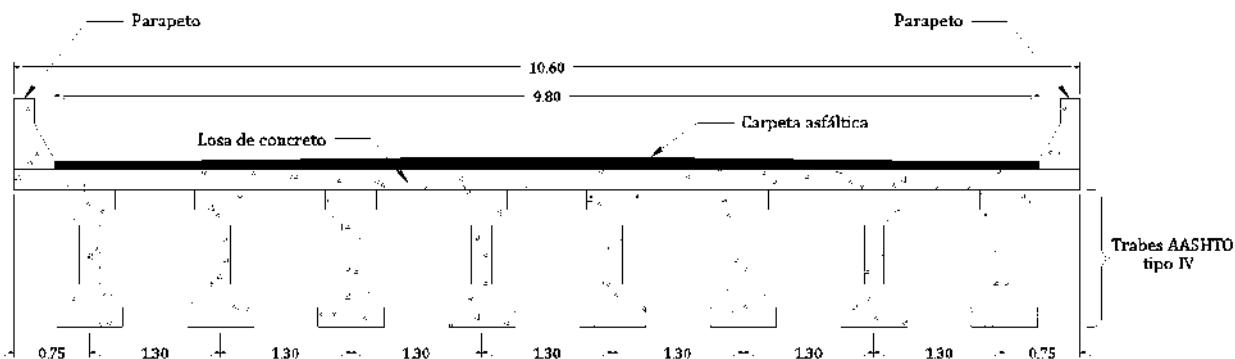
Sección transversal de la superestructura de los puentes (acotación en metros)
